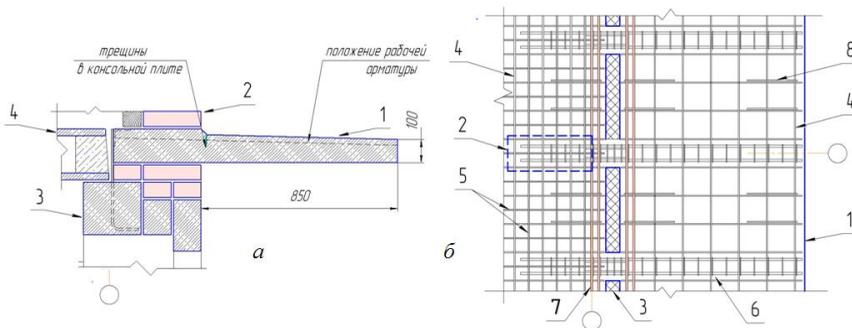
Конструктивное решение балкона из сборной железобетонной плиты для зданий с кирпичными стенами (а) и схема армирование плиты балкона монолитного здания (б)
